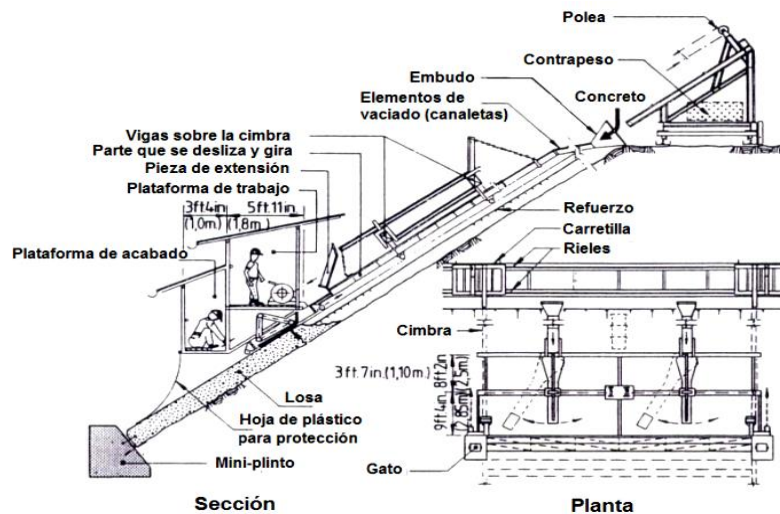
Esquema de la cimbra deslizante utilizada en la presa de Khao (Watakeekul et al. 1985)
